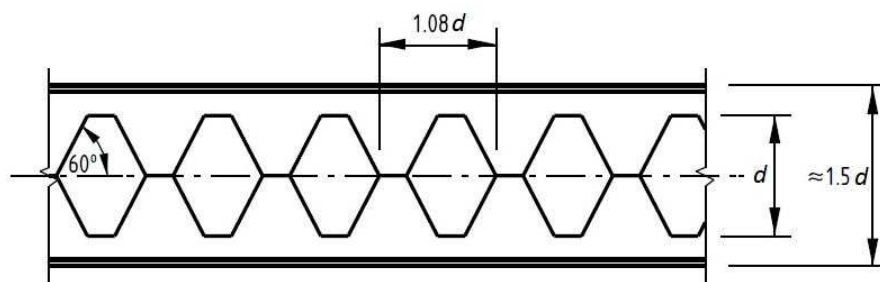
Viga castelada padrão anglo-saxão (adaptado de BS 5950-1:2000).
